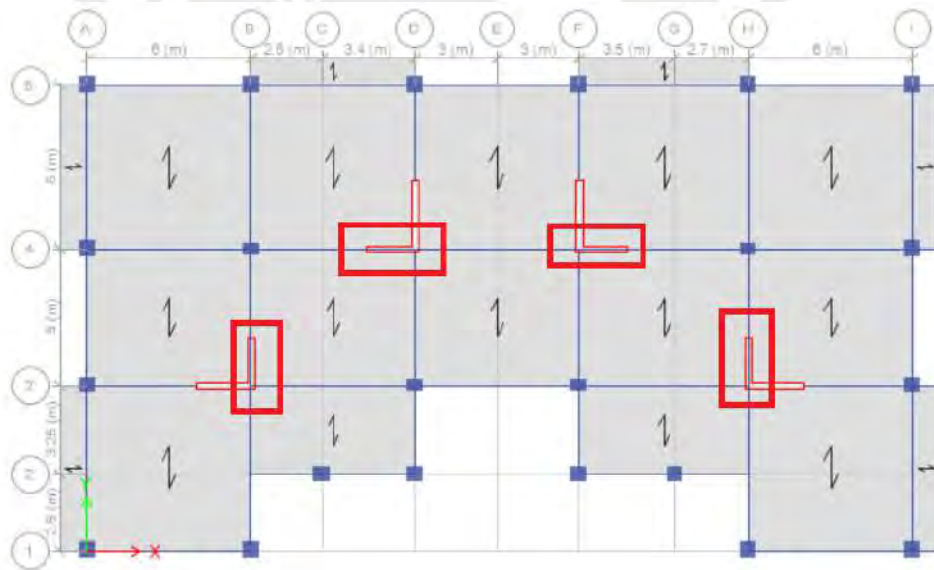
Planta del modelo reforzado con encamisados de concreto armado y la adición de placas
